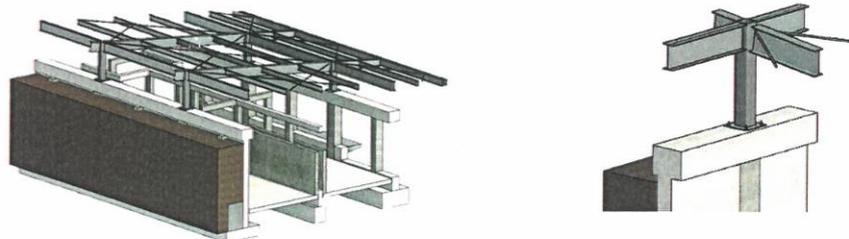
VISTA DE DETALLES DEL ELEMENTO METALICO EN SSHH - ORATORIO
